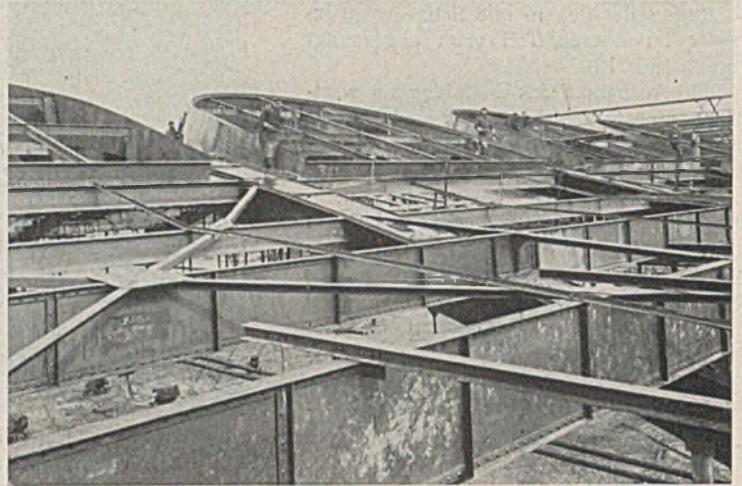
Halle III. Die fertigmontierte Dachkonstruktion.
